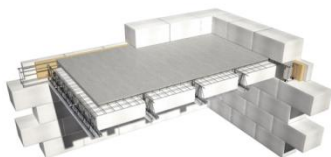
Схема сборно-монолитного газобетонного перекрытия
